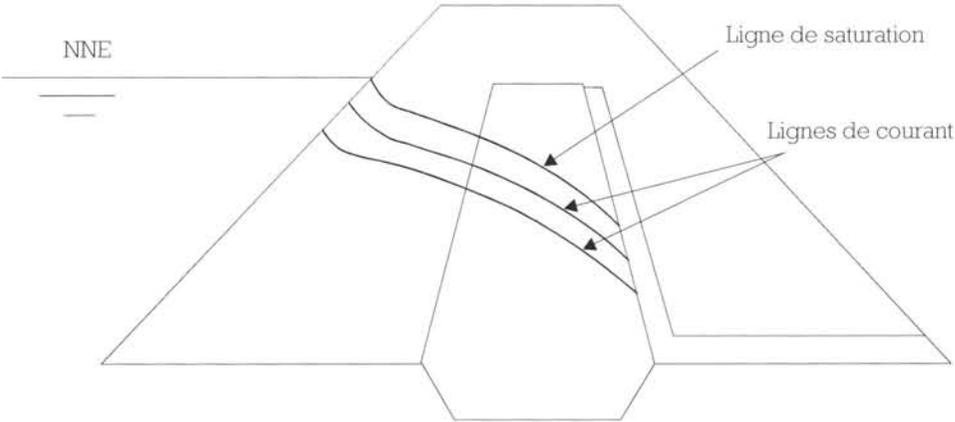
Ligne de saturation dans un barrage à noyau.
